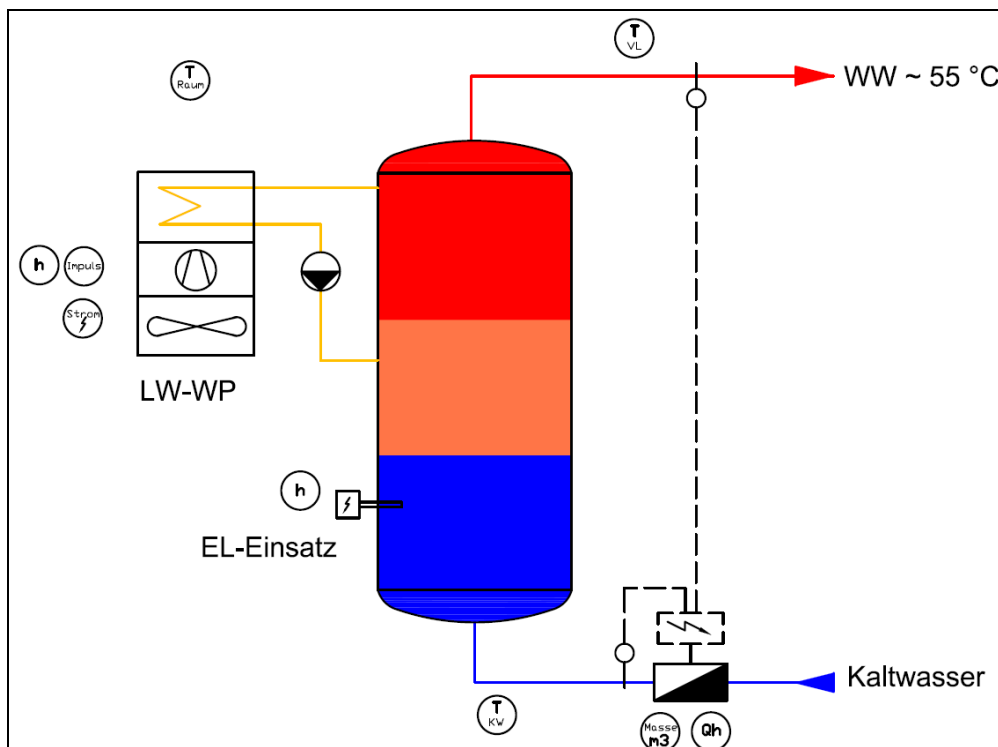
Messstellenplan für Warmwasser-Wärmepumpen
